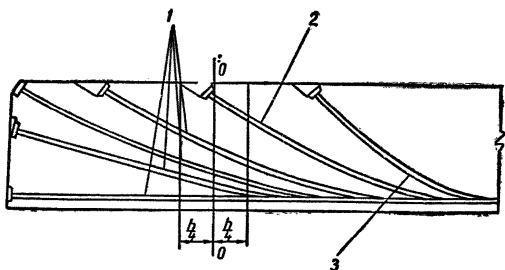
Схема расположения пучков, учитываемых при расчете на главные растягивающие напряжения для сечения $O-O$
